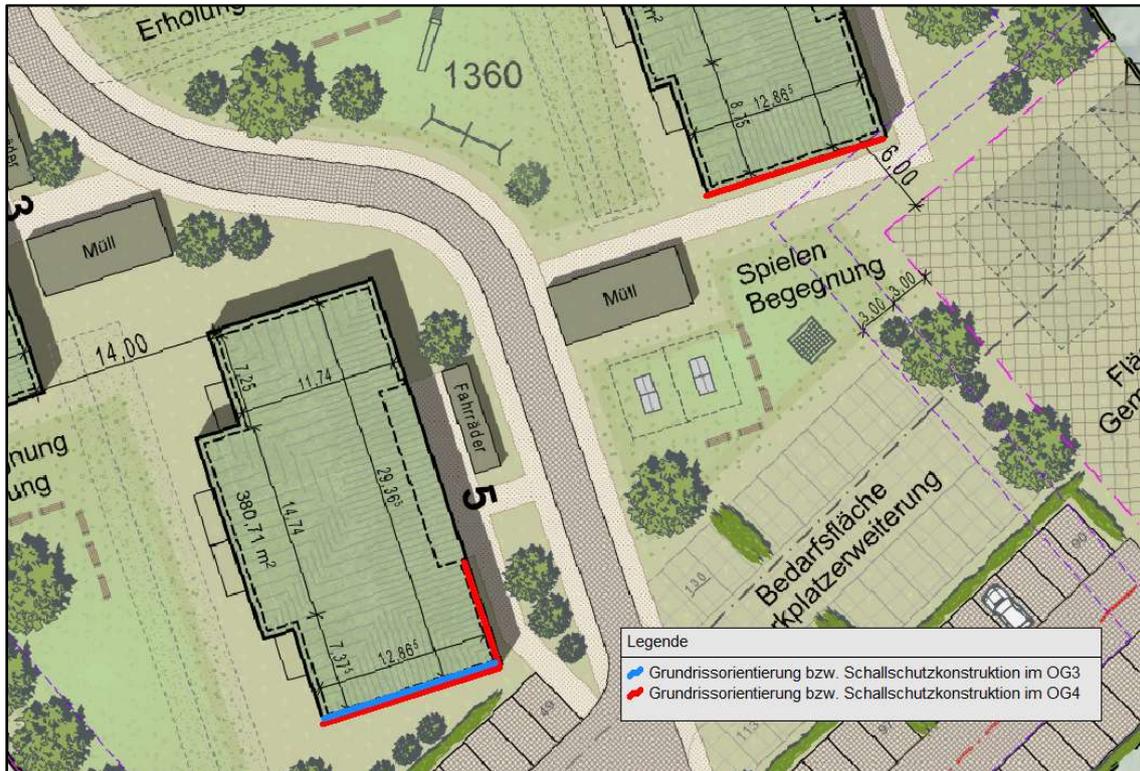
Auszug Schalltechnische Untersuchung - Fassadenteile mit Handlungsbedarf
